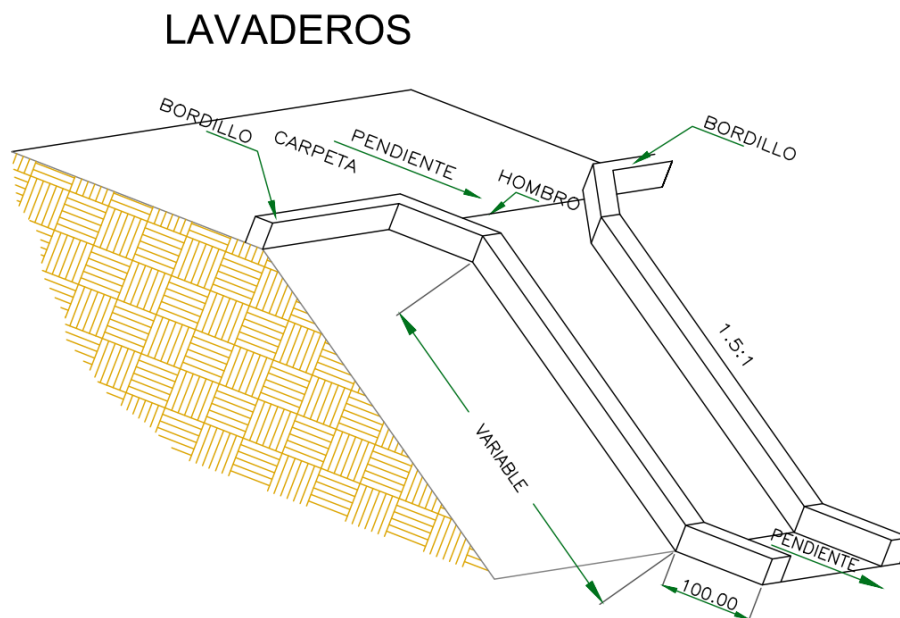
Detalle de los bordillos a construirse, en el proyecto.
